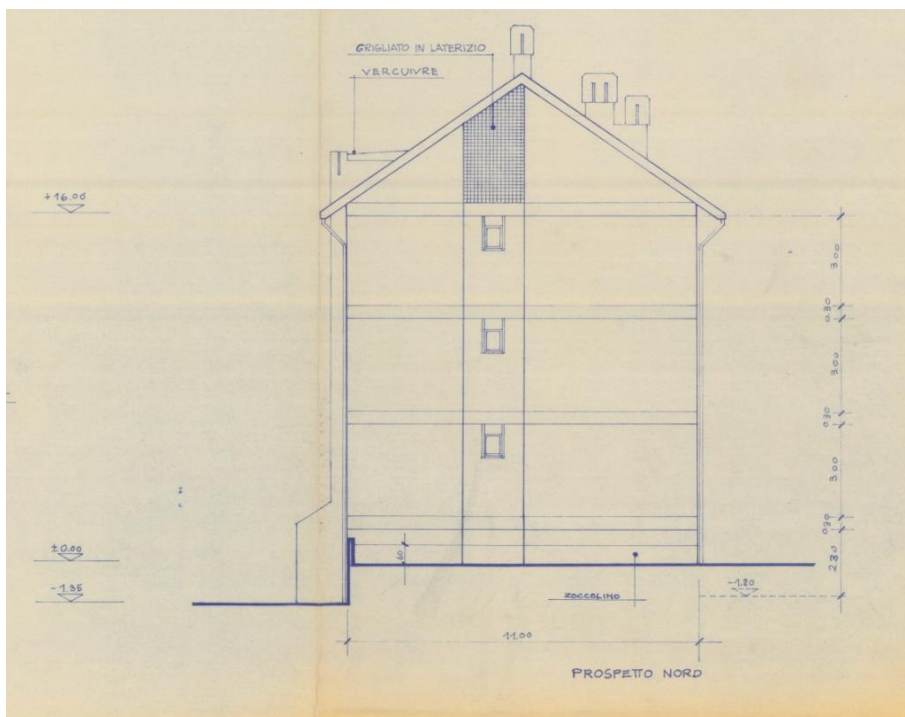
, Prospetto Nord-Ovest, scansione progetto originale
